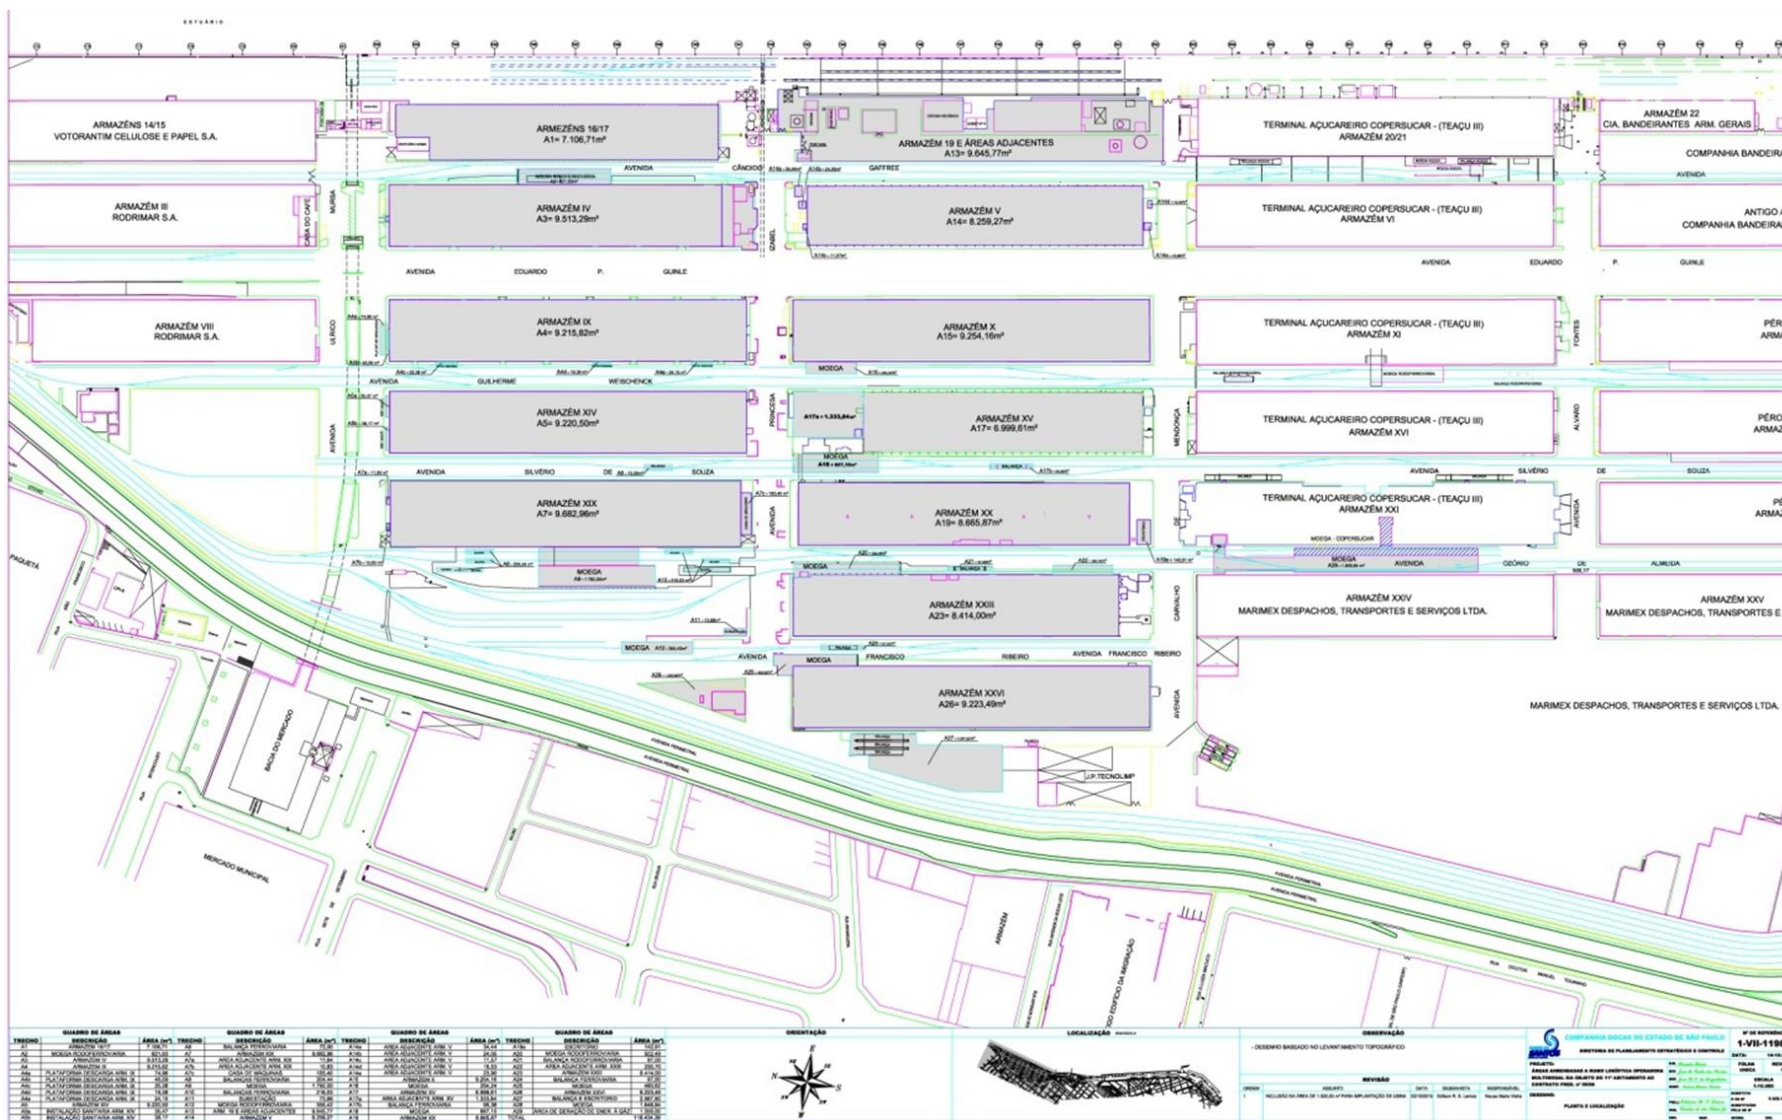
Planta planialtimétrica da área arrendada objeto do contrato PRES n° 05/96
